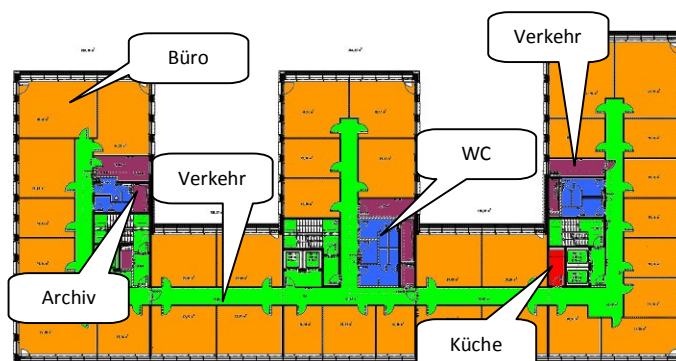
Grundriss Regelgeschoss mit Zonierung, Geb.6
